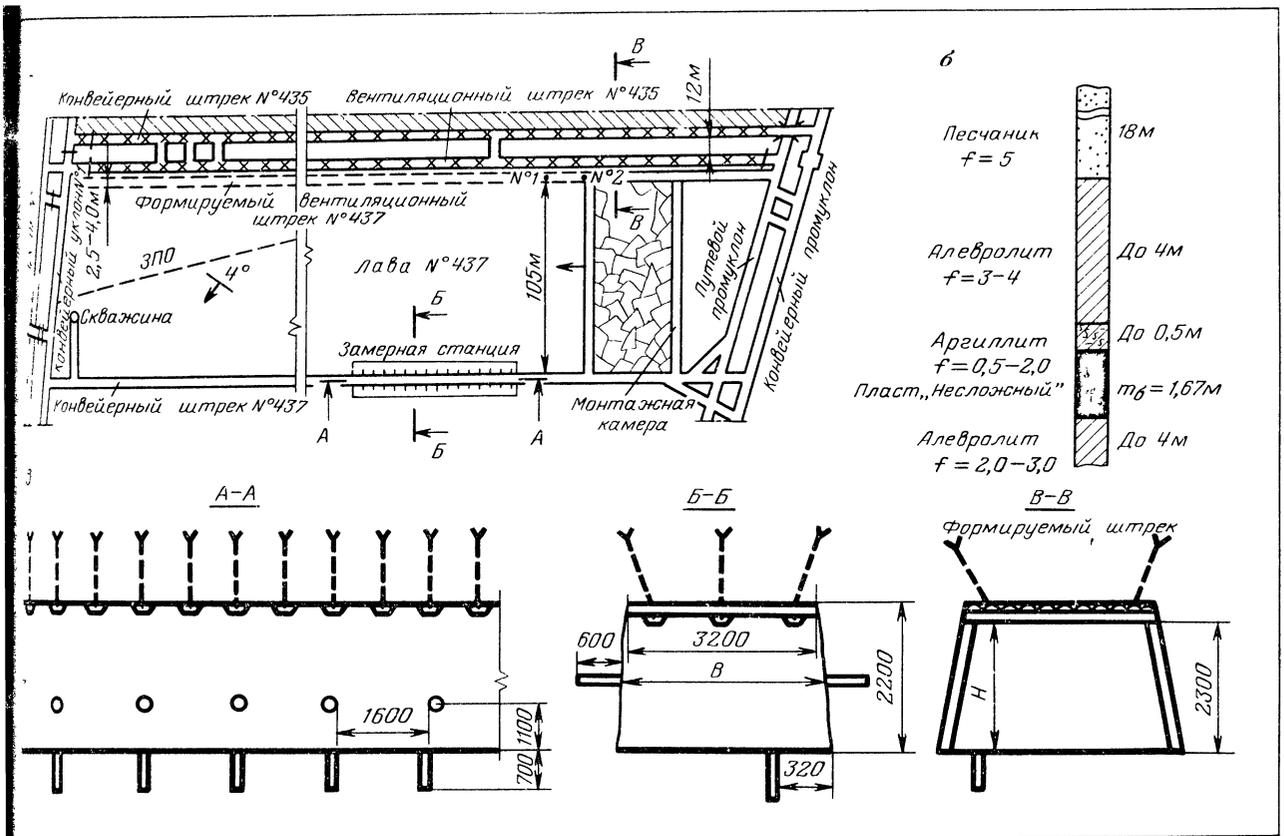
Выкопировка из плана горных работ лавы № 437:
